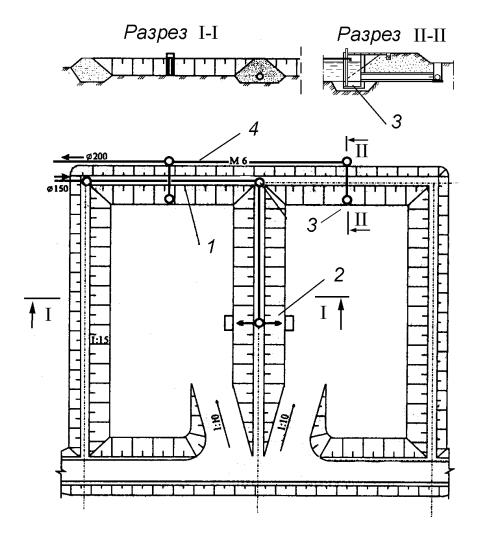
Иловые площадки на естественном основании без дренажа с поверхностным отводом иловой воды: 1 - распределительный трубопровод; 2 - сливной лоток; 3 - колодец-монах; 4 - трубопровод иловой воды.
